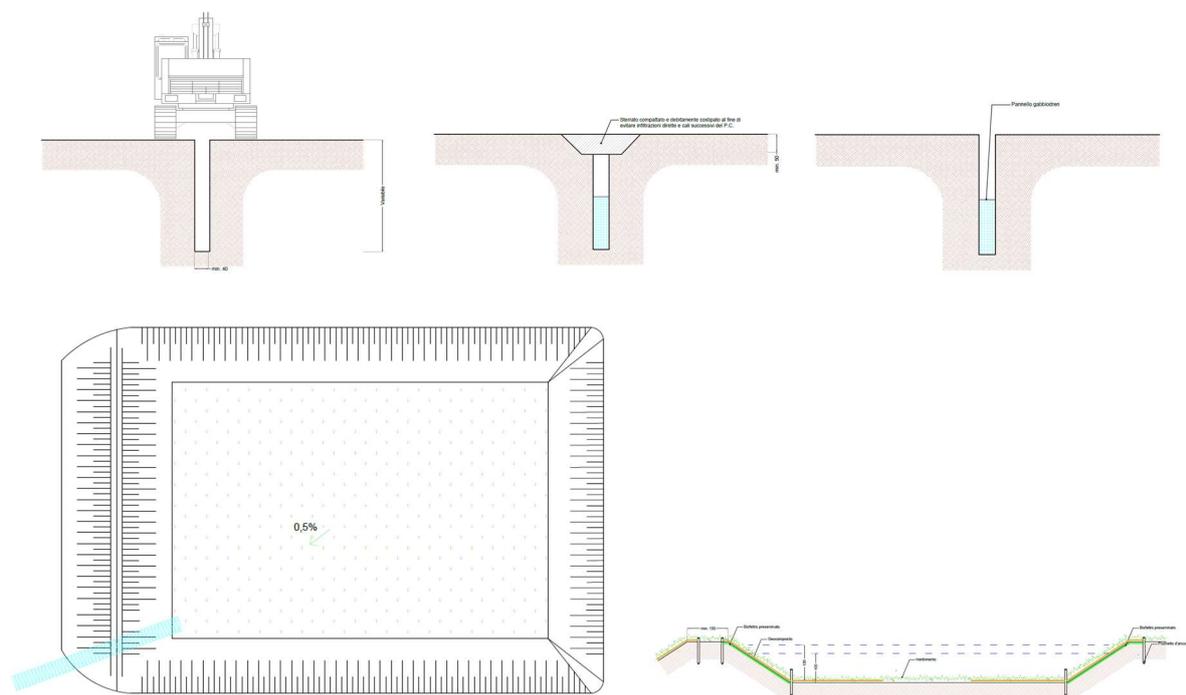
sezione e pianta tipo di trincea e laghetto di laminazione
